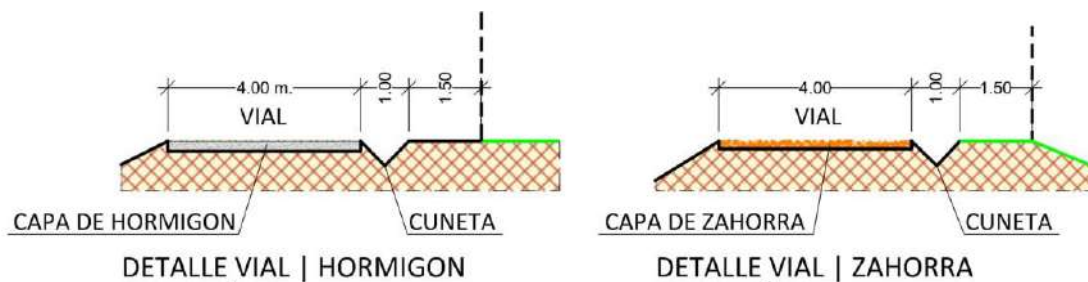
Secciones tipo de camino de servicio con zahorra y pavimento de hormigón
